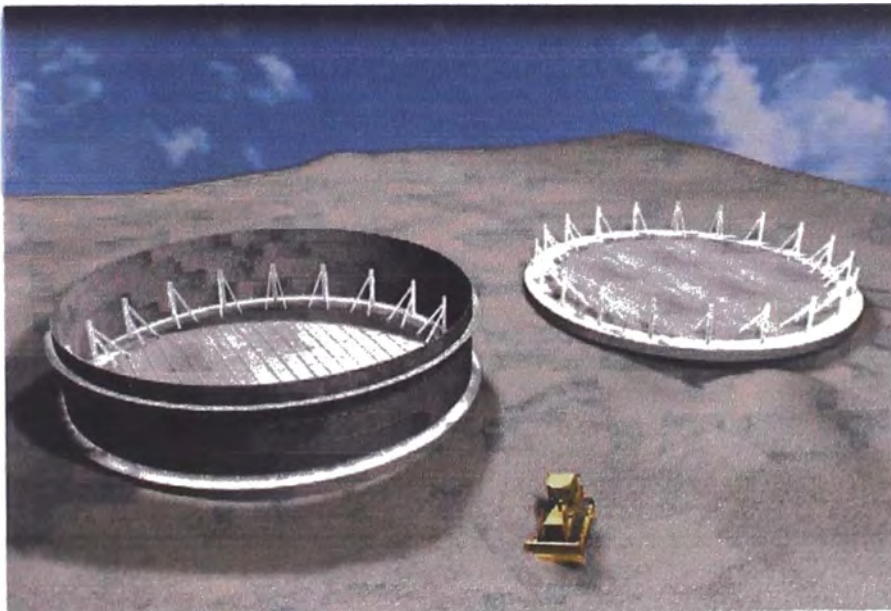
Construcción del tanque mediante la técnica del ganeo
